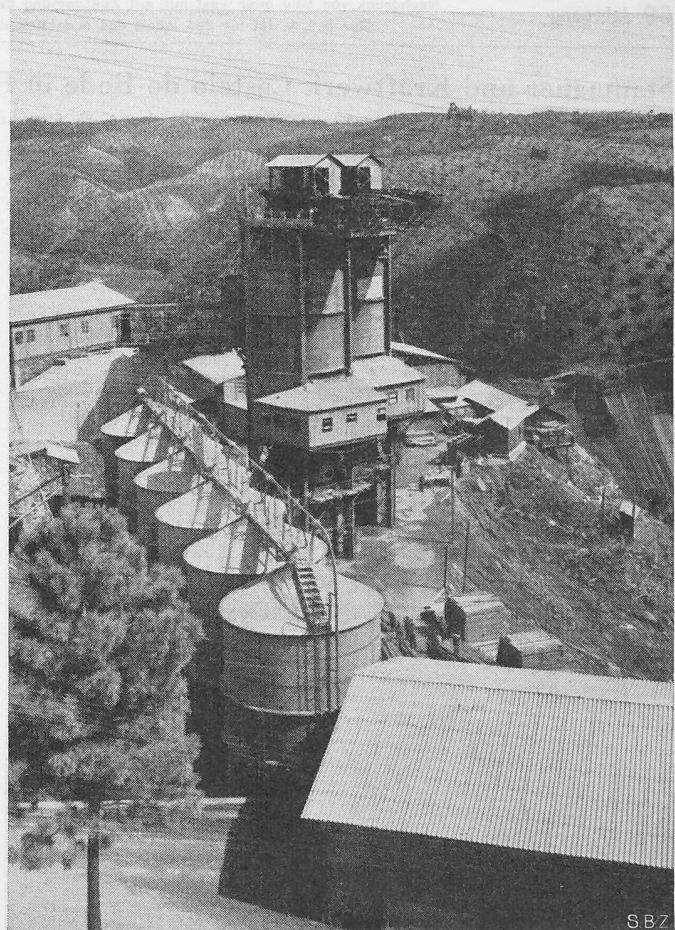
Zementsilos; dahinter Betoniertürme mit Endstation der Luftseilbahn
